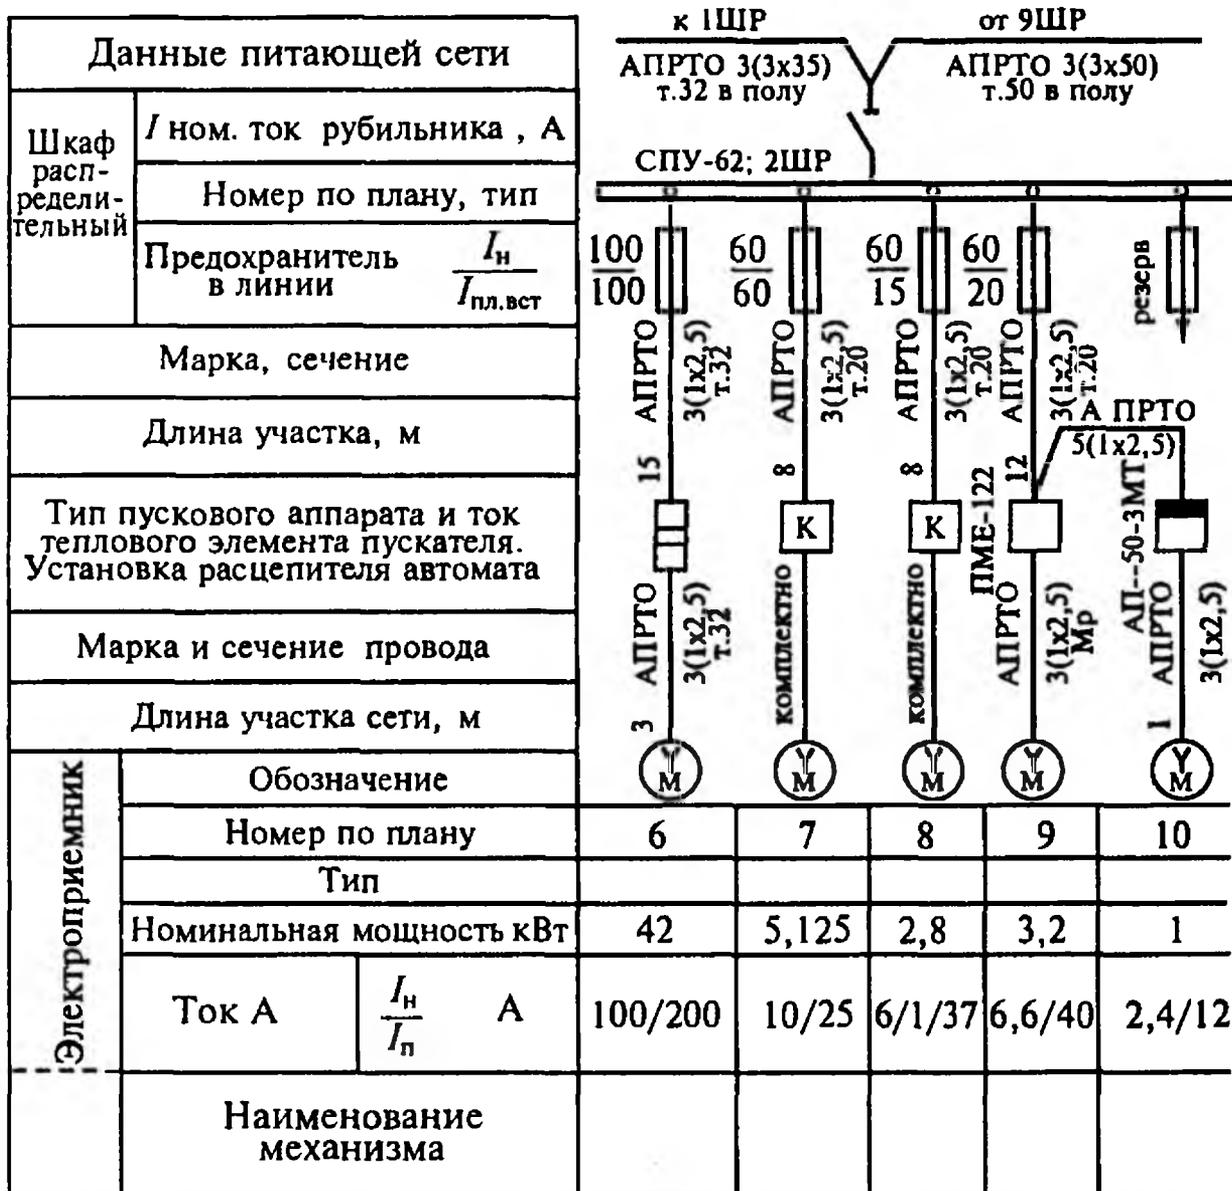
Пример расчетной схемы распределительного шкафа
